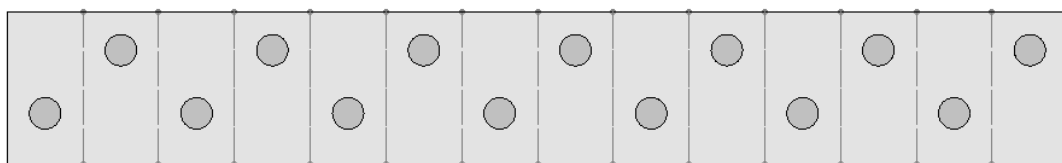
Vista de planta de la distribución 2 de los ventiladores de techo
